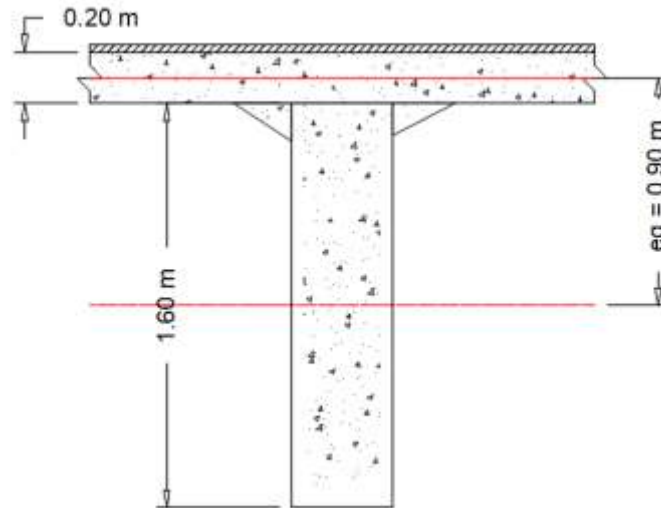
Distancia entre los centros de gravedad de la viga y la losa.
